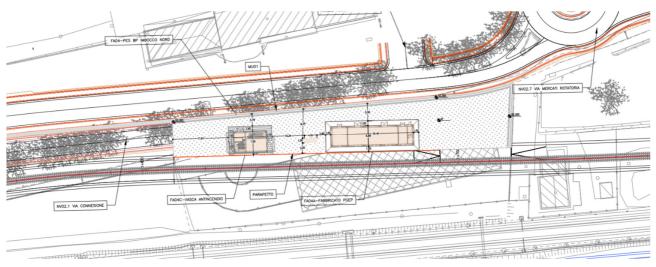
PLANIMETRIA DI PROGETTO FA04
